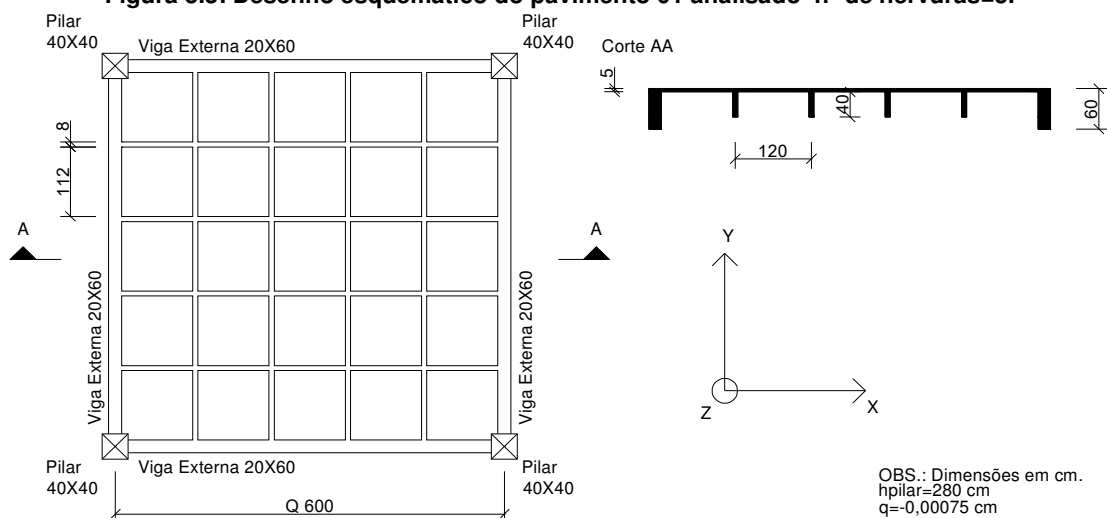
Desenho esquemático do pavimento 01 analisado n° de nervuras=4.
